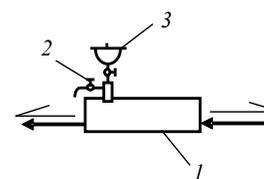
Способ удаления воздушных скоплений из систем водяного отопления с верхней разводкой:
